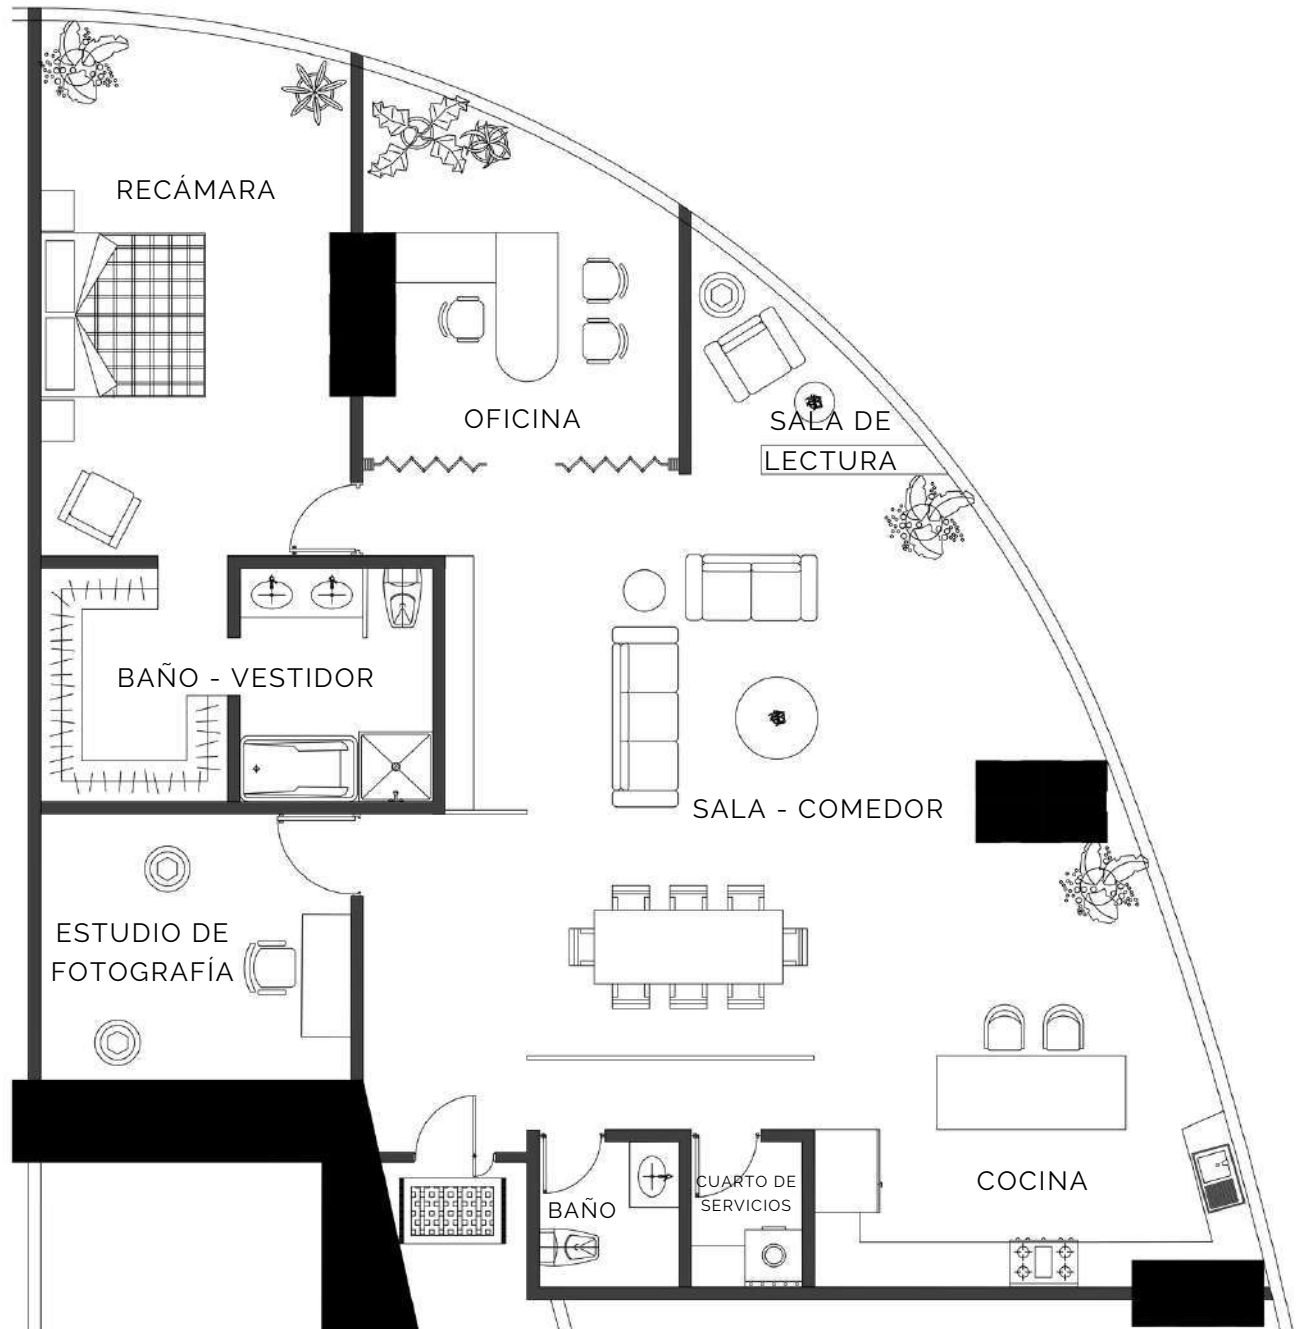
Planta de departamento 1. Fuente: Autoría propia.
